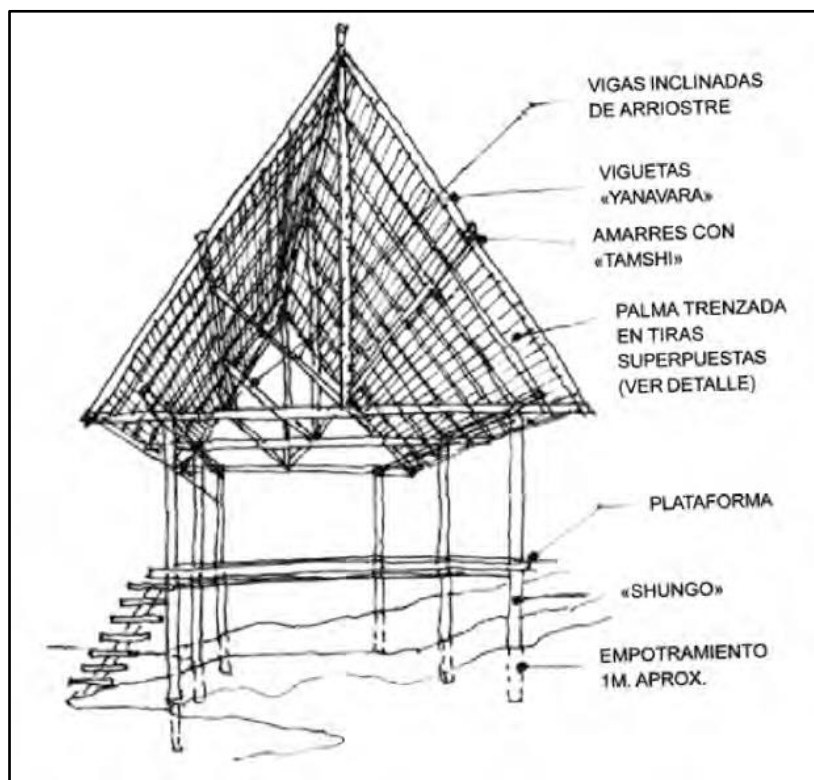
Sistema constructivo estándar de viviendas rectangulares.
